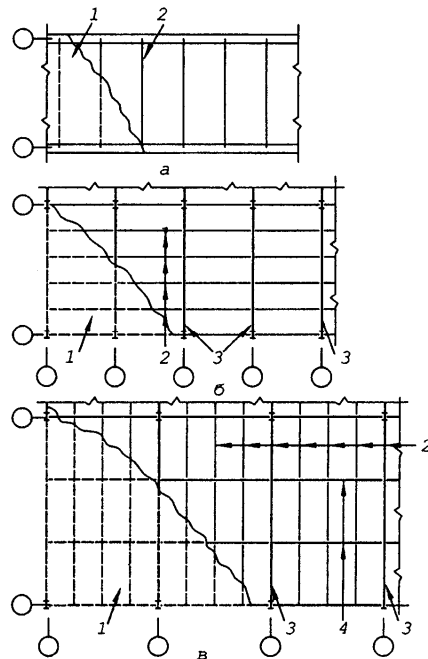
Типи балкових кліток: а – спрощений; б – нормальний; в – ускладнений; 1 — настил; 2 — балки настилу; 3 – головні балки; 4 – допоміжні балки
